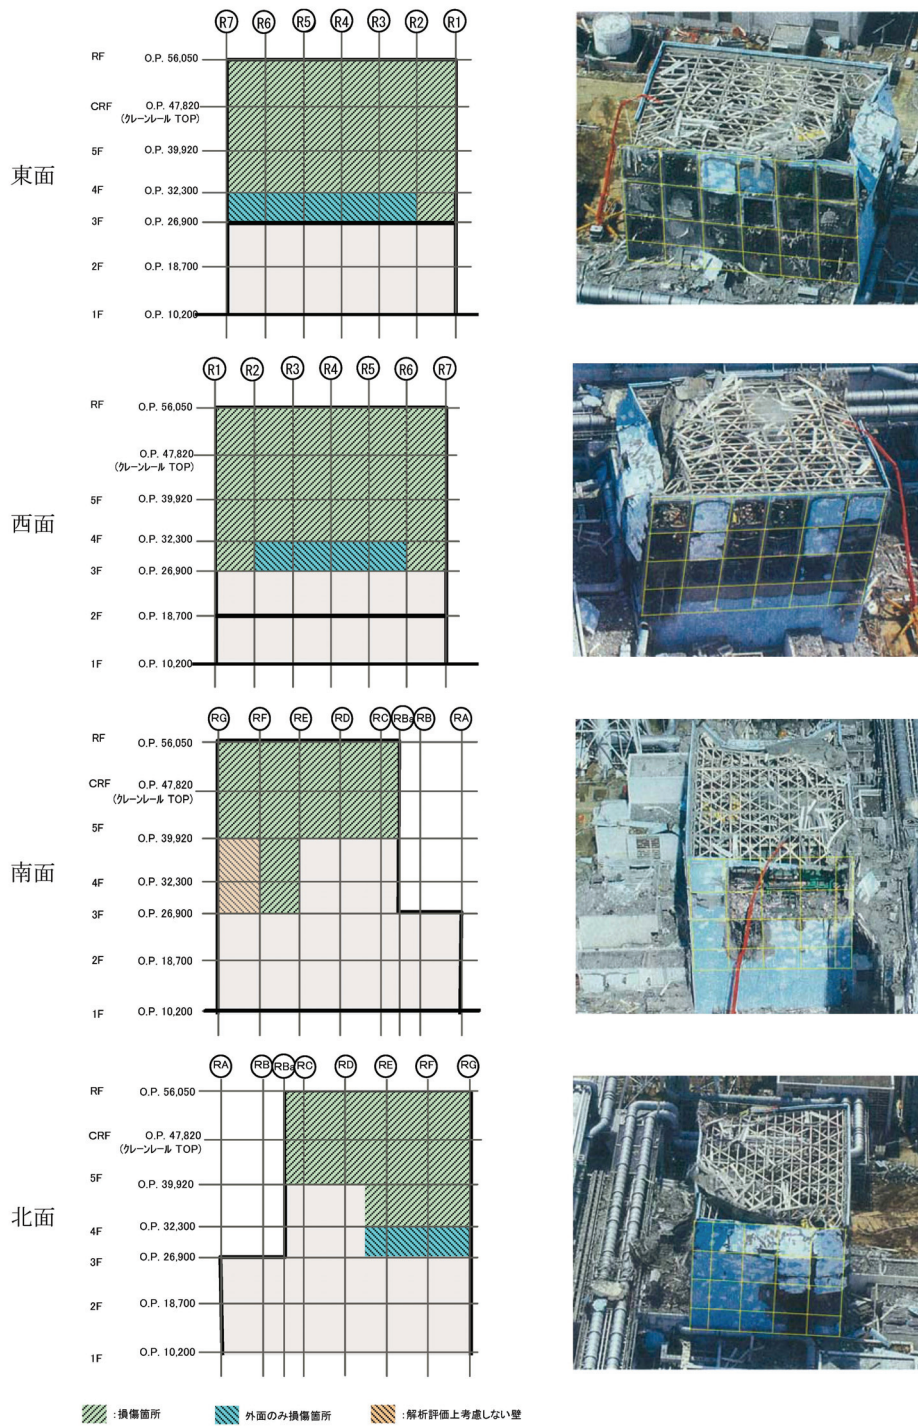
4号機原子炉建屋の損傷状況（立面図）
